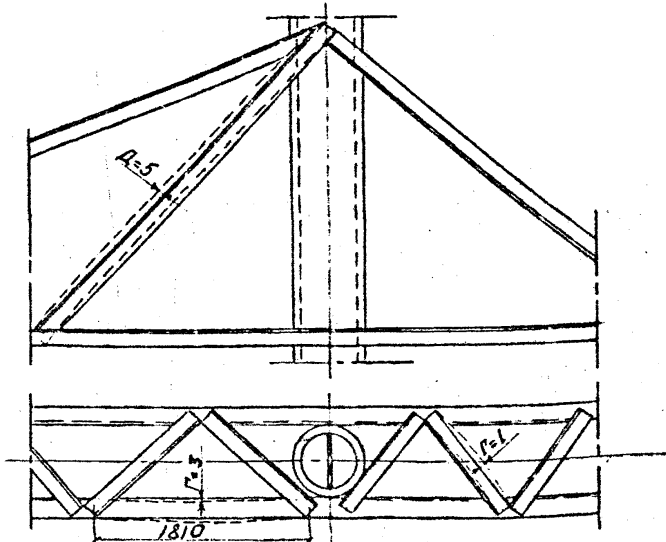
Допуски на сборку одноэтажных анкерно-угловых железобетонных опор
